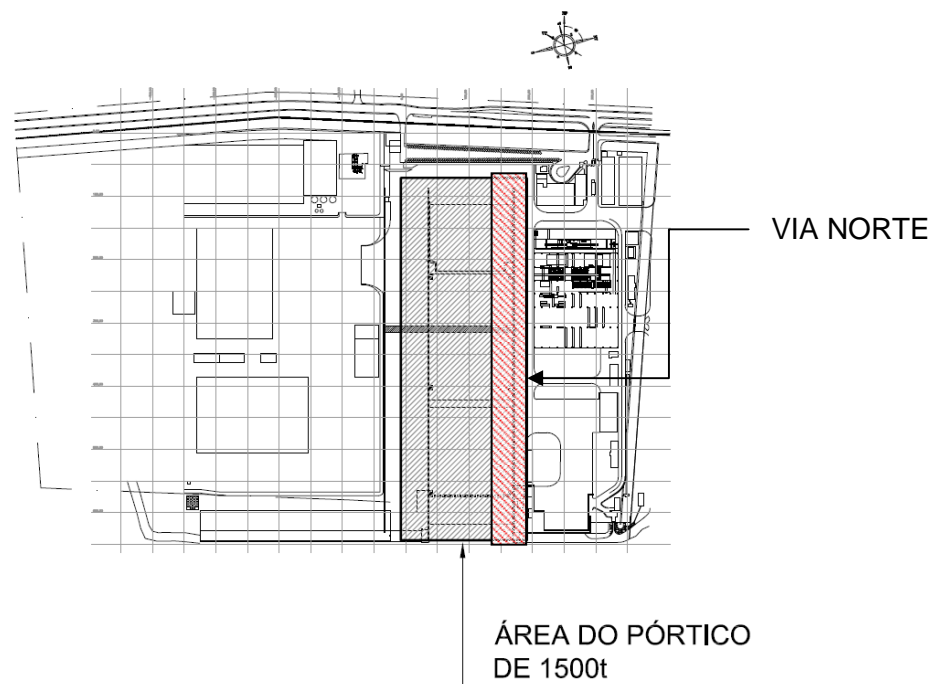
Planta geral – área do pórtico e via Norte.
